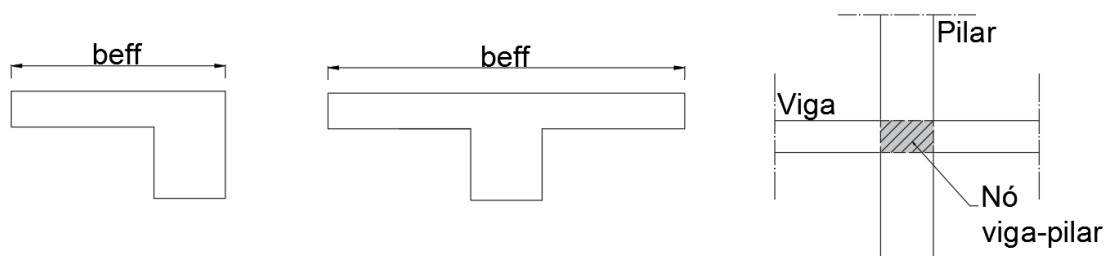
Seções transversais assumidas para os elementos estruturais.
